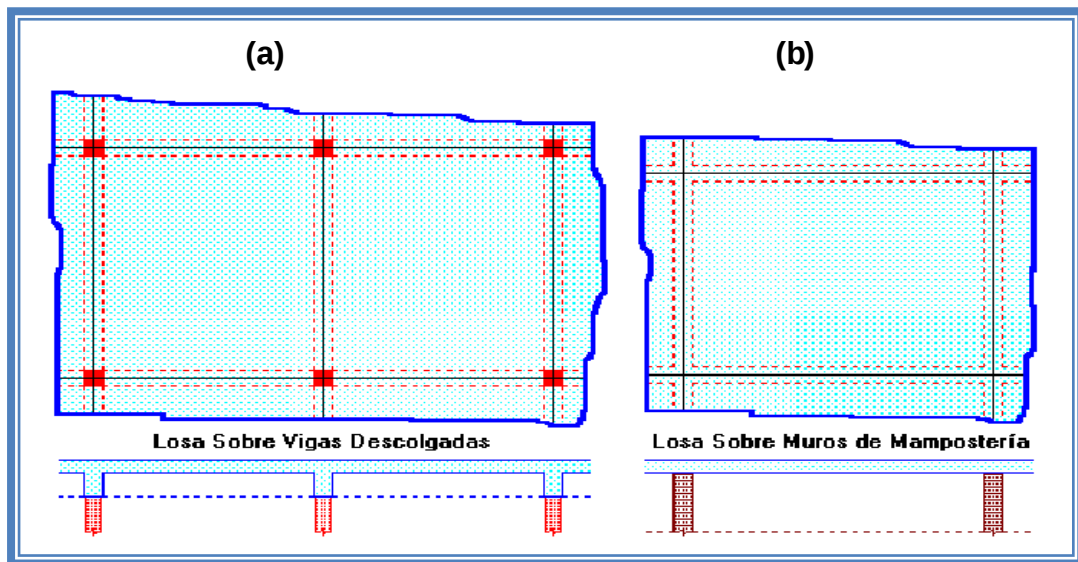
a) Losas apoyadas sobre vigas; b) Losas apoyadas sobre muros. Fuente: <http://www.manualespdf.es/manual-losas-concreto/>
